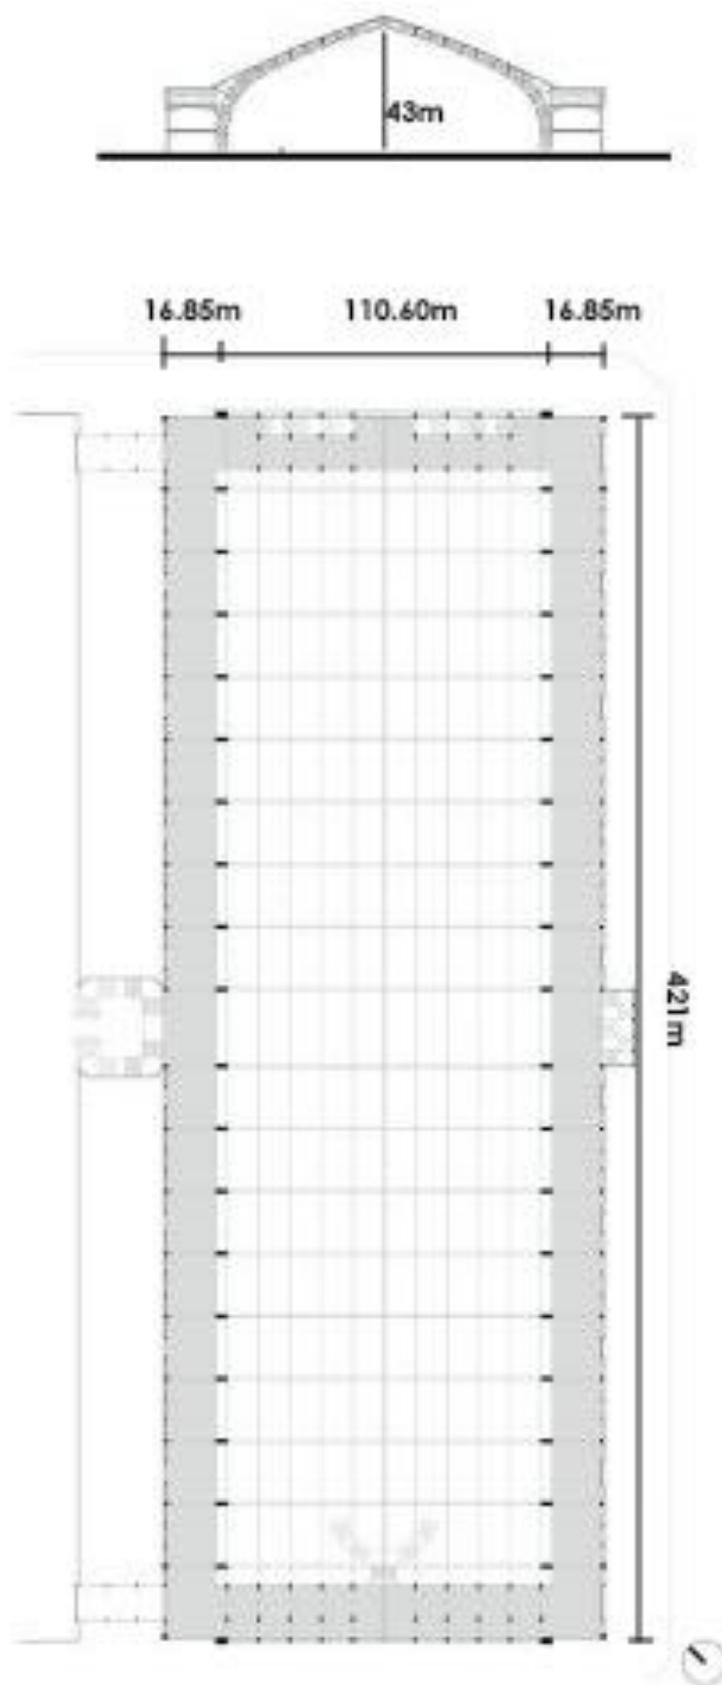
Planta y sección del pabellón de la Galería de las Máquinas de 1889. (Linares de la Torre, 2018)
